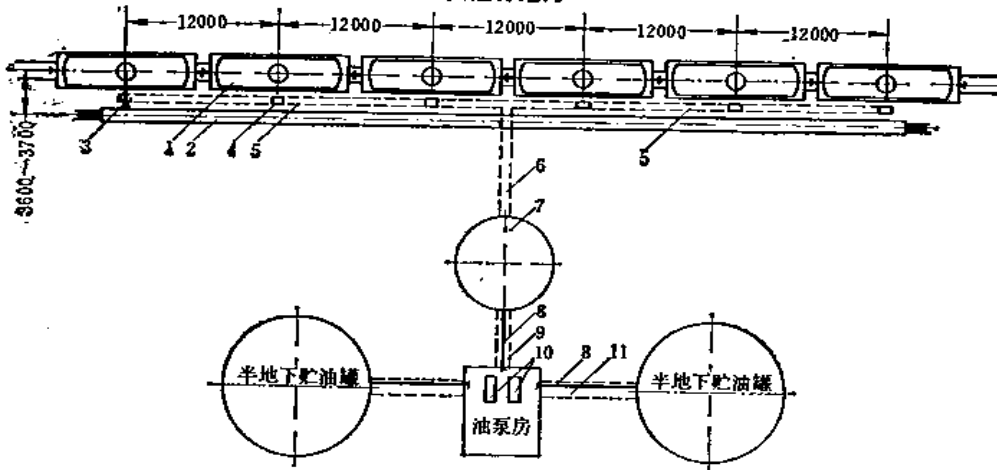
短管下卸(敞开式)设施(带卸油罐)平面布置图
